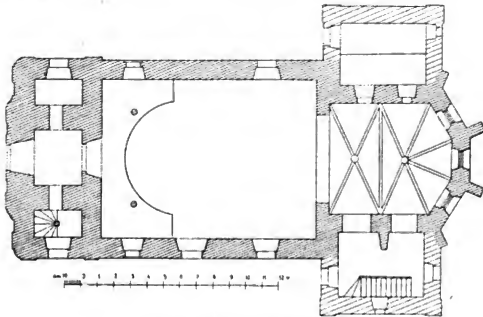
Liblitz. Grundriss der Kirche.
